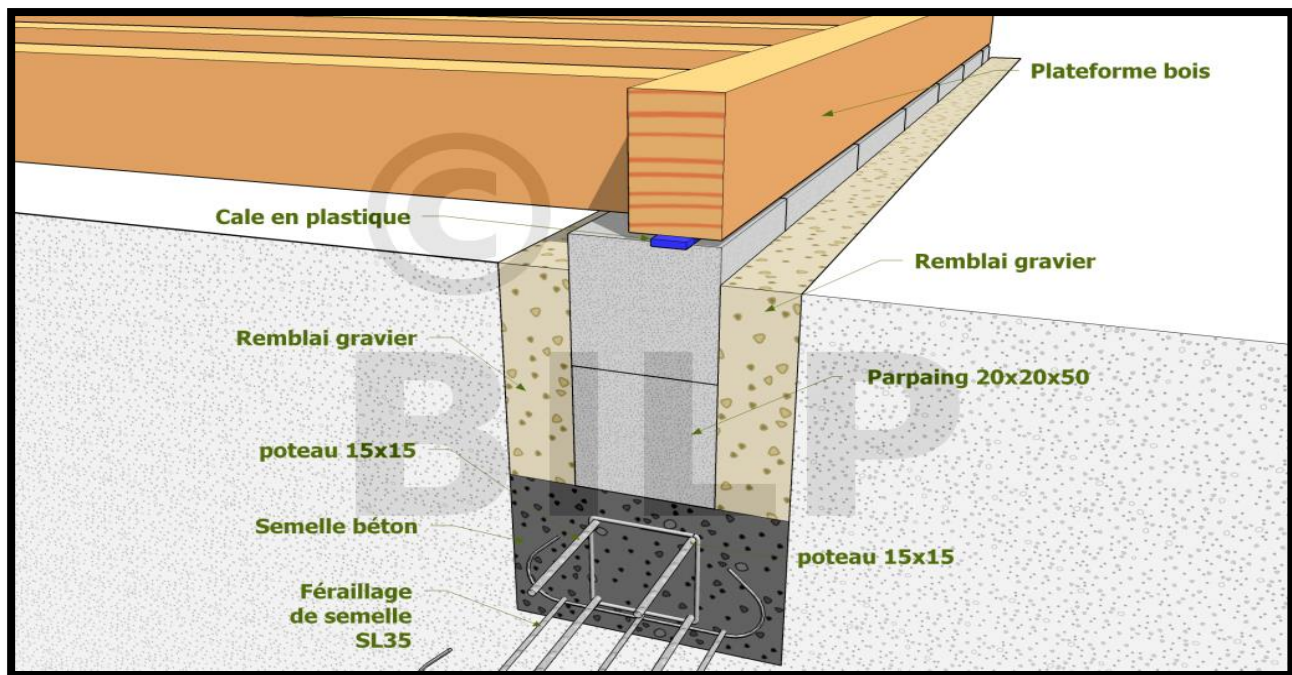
vue en coupe qui montre le détail d'une semelle filante
